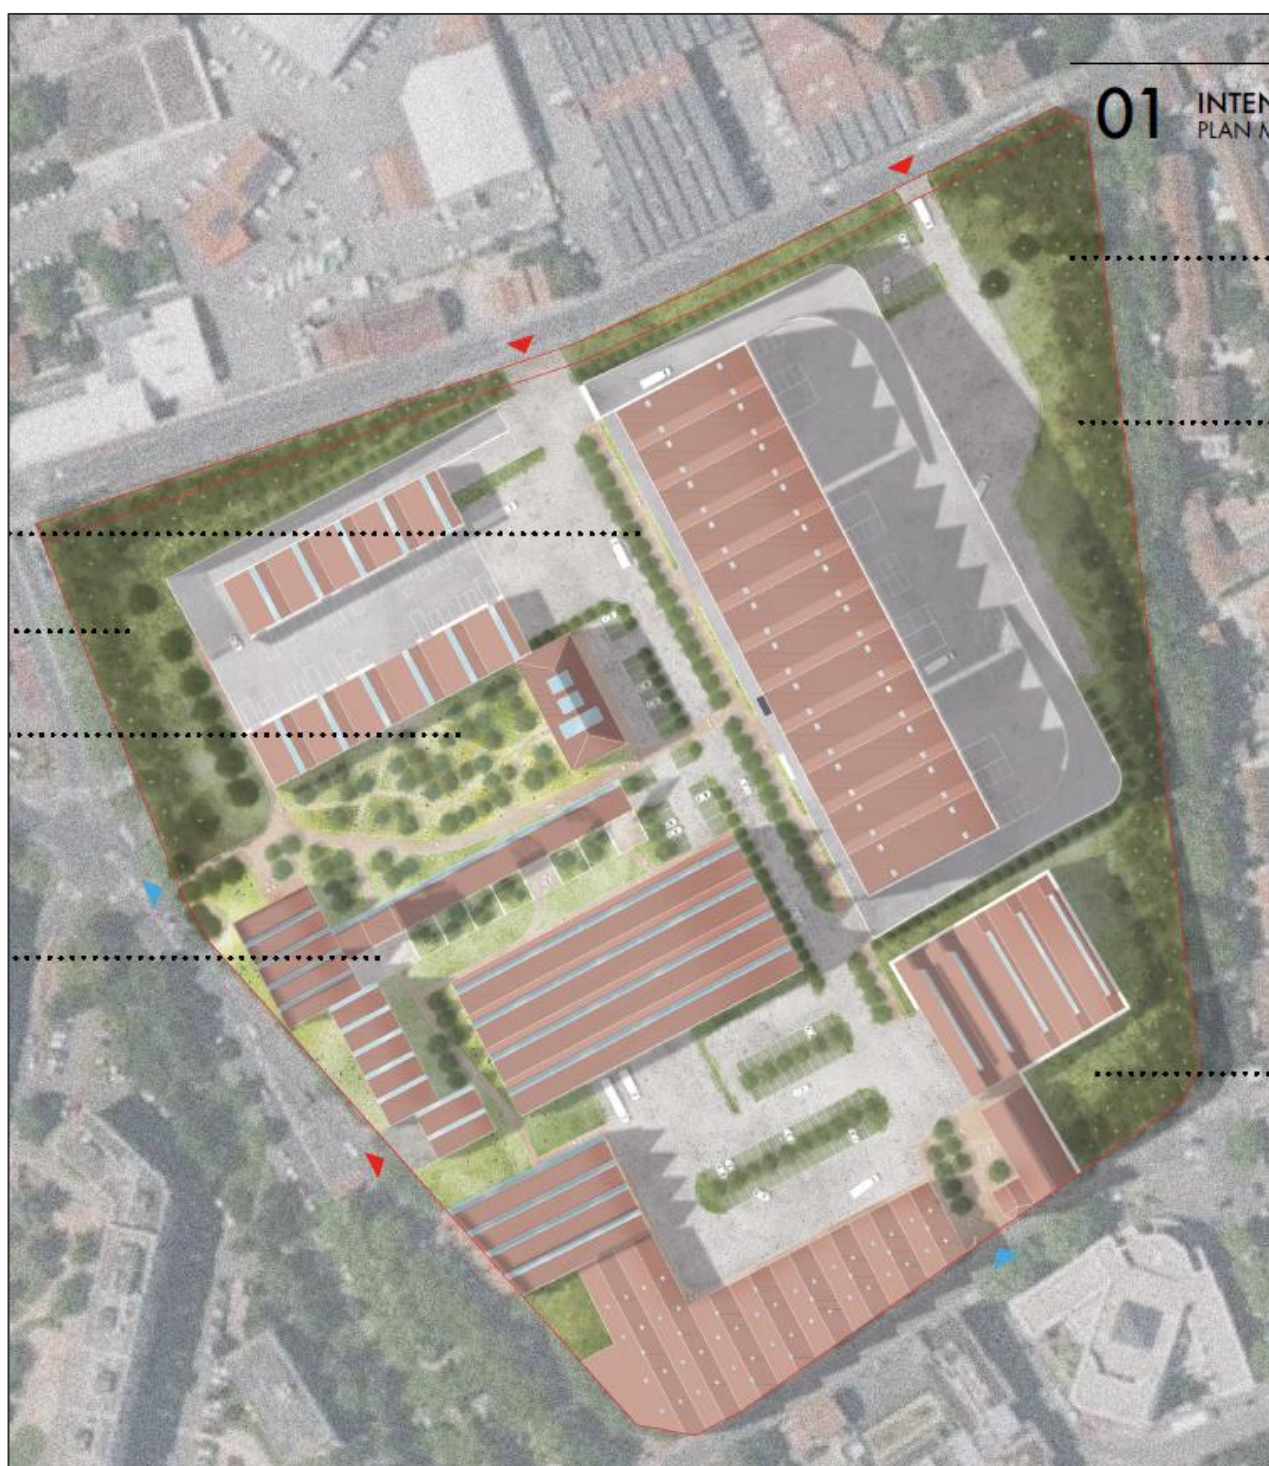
Plan masse du projet (Source : Yannick Goetz architecte DPLG, 2024)
